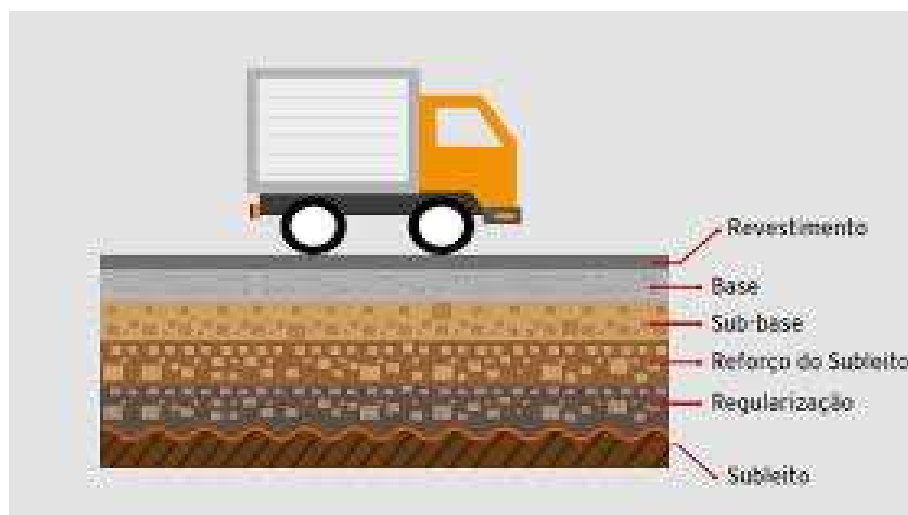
Constituição do pavimento flexível (Fonte: Albano, 2013)
